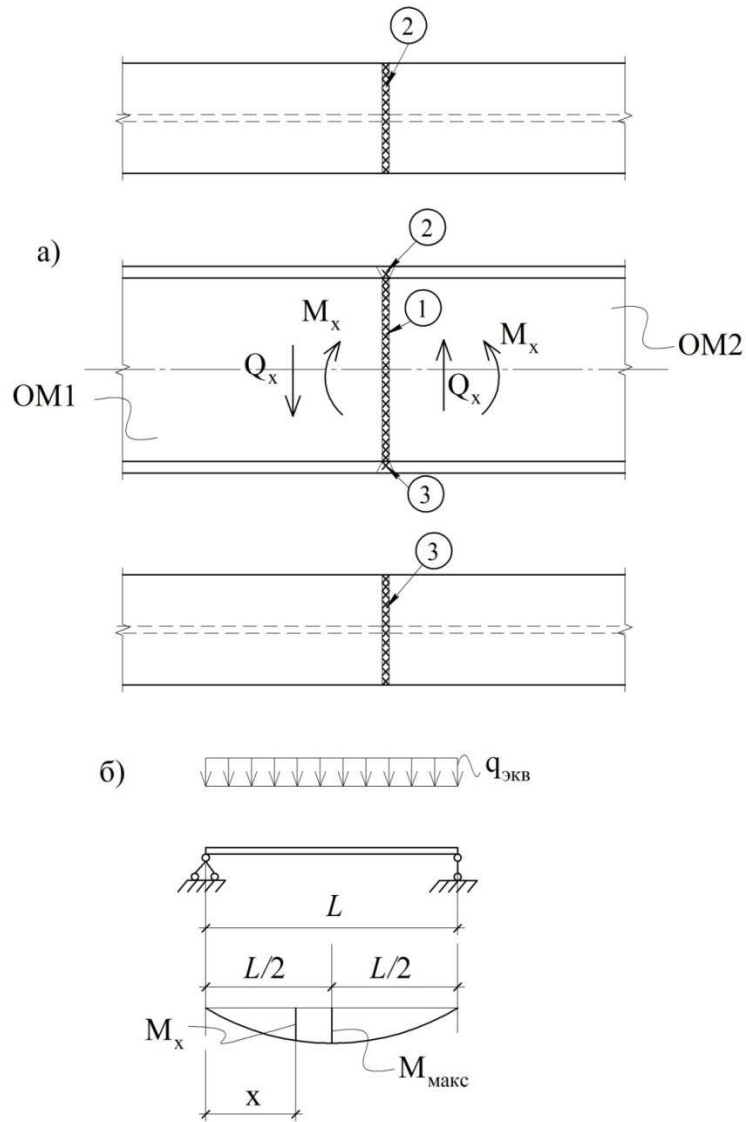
Сварной заводской стык прокатной балки.
